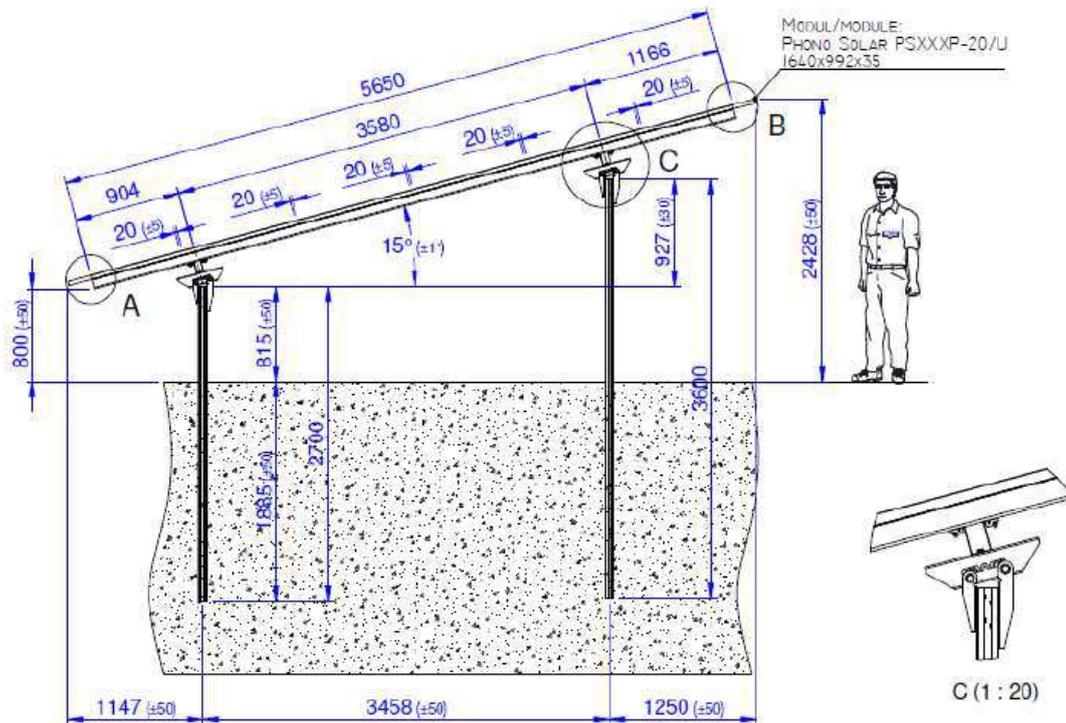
Sección en planta de las estructuras de sujeción.
